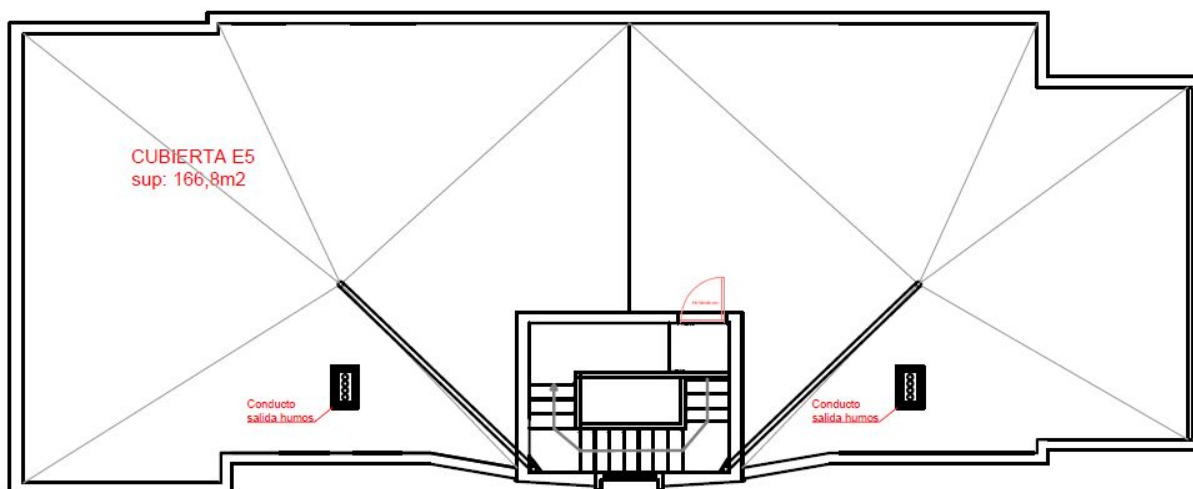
Planta del bloque H, escalera 5, cubierta plana (Fuente: Anejo A)
